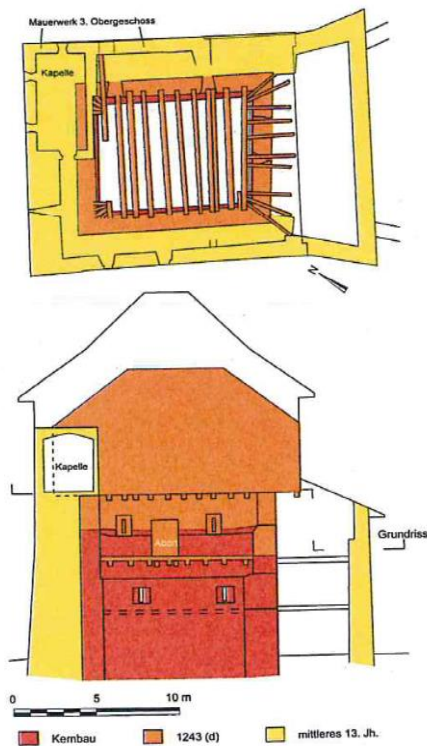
Bauabschnitte Grundriss und Ansicht
